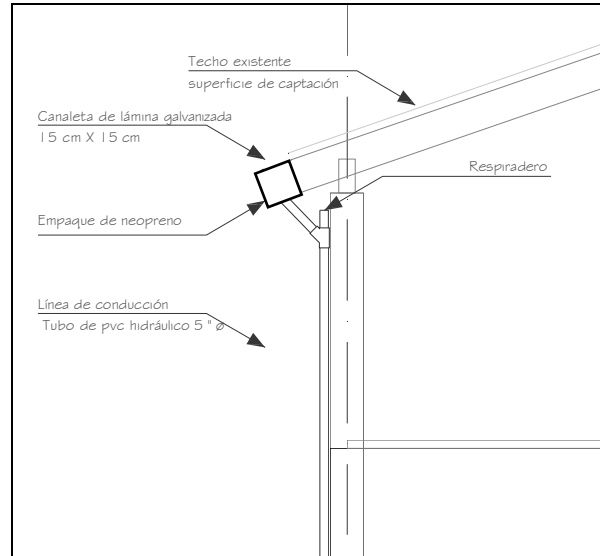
Canaleta y tubería de conducción. Figura 19. Corte longitudinal esquemático para la zona de trucheros
